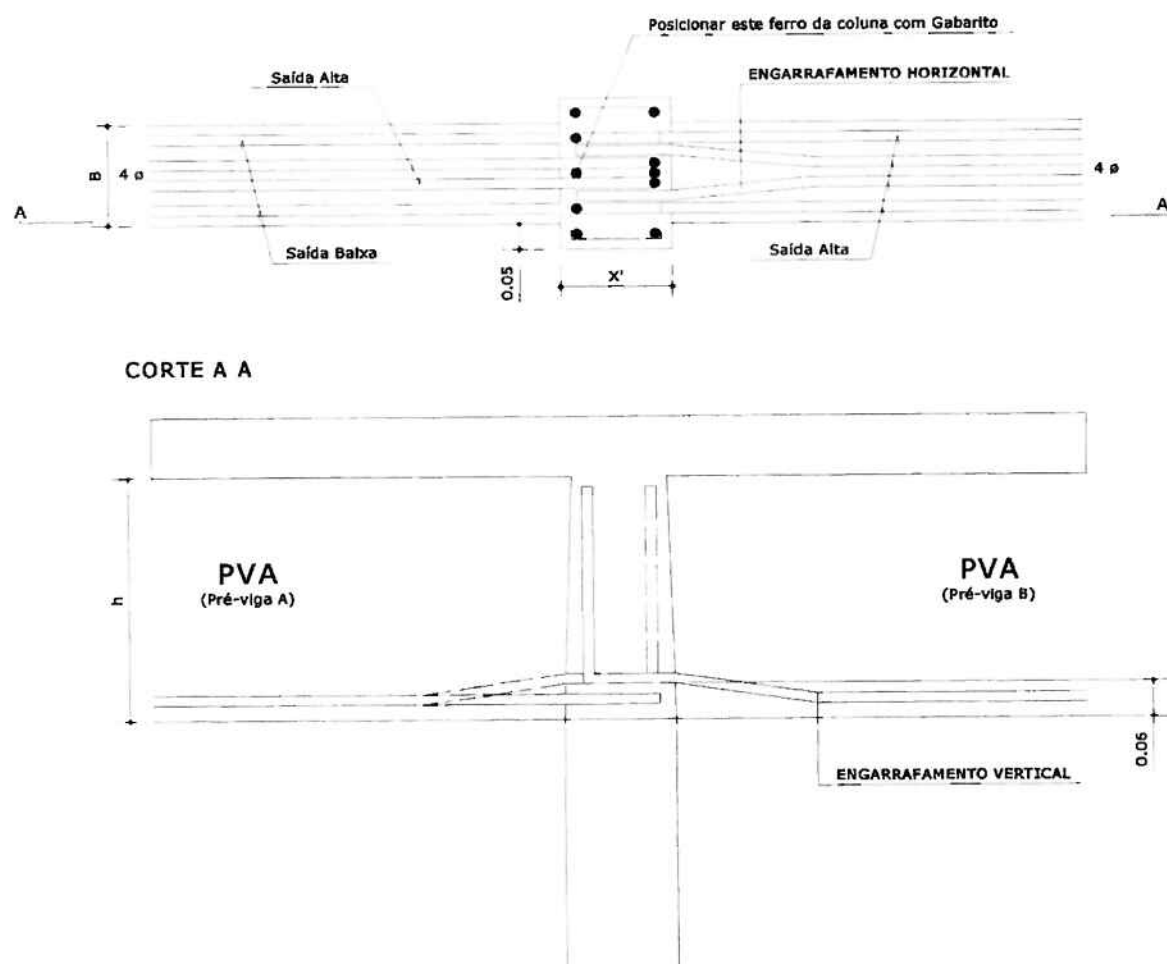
Detalhe genérico do engarramento horizontal e vertical da viga com a armação da coluna
